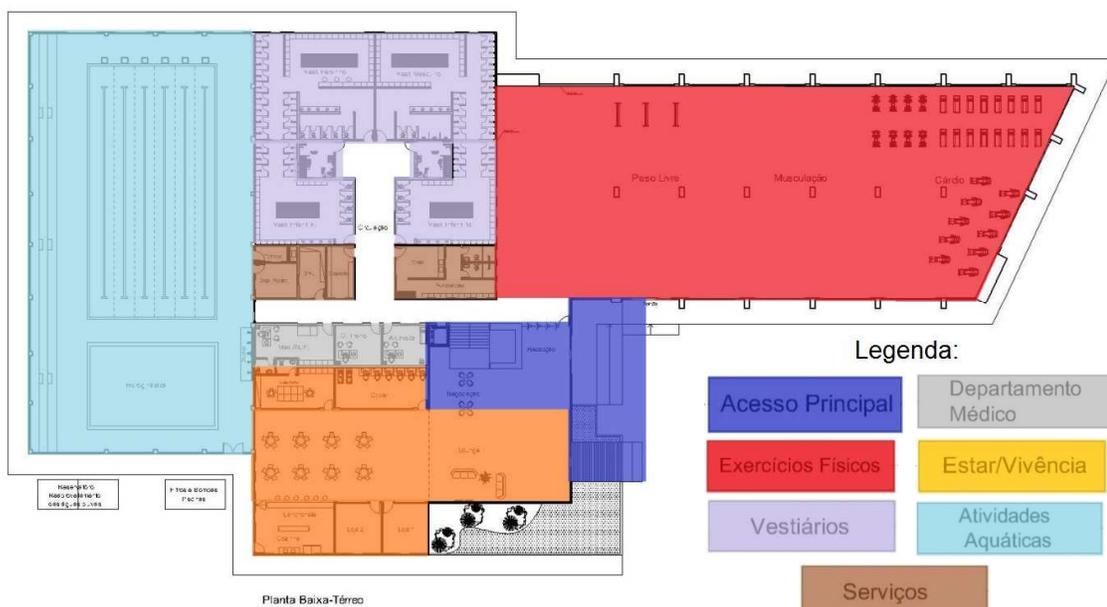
Setorização do Pavimento Térreo. Fonte: O Autor
